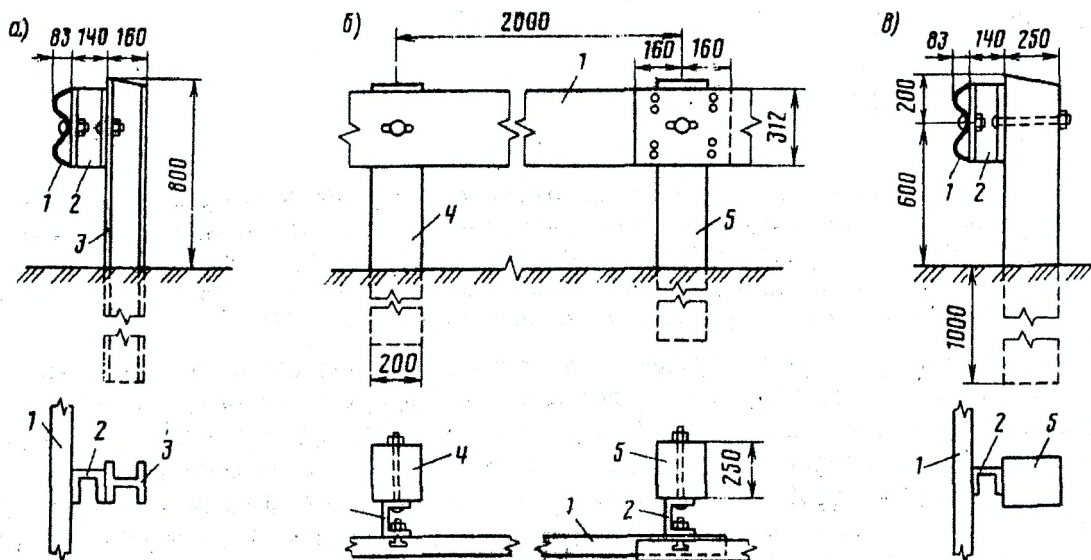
Барьерное ограждение из стальных планок, закрепленных через амортизаторы к стойкам (типовой проект 3.503.1-89): а – к металлическим; б, в – к железобетонным; 1 – планка; 2 – амортизатор; 3 – металлическая стойка; 4 – промежуточная железобетонная стойка; 5 – основная железобетонная стойка
